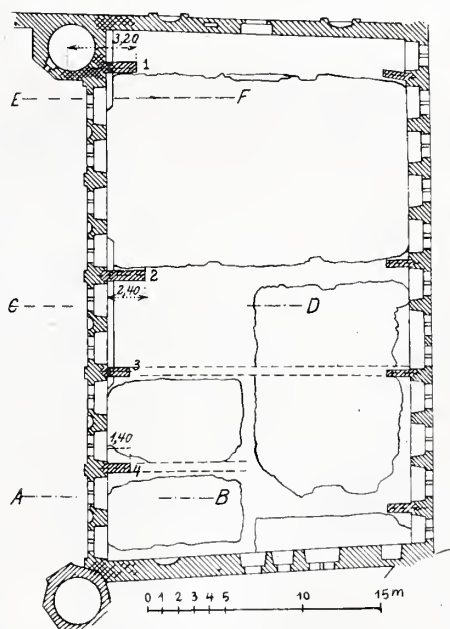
Grundriss. — Masstab 1 : 500.
